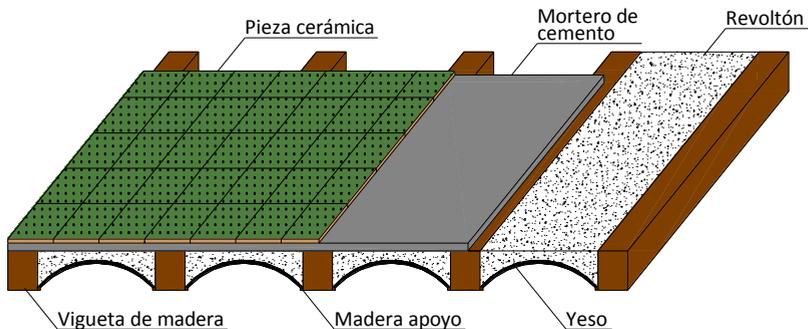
Detalle constructivo tipo del forjado de la vivienda.
